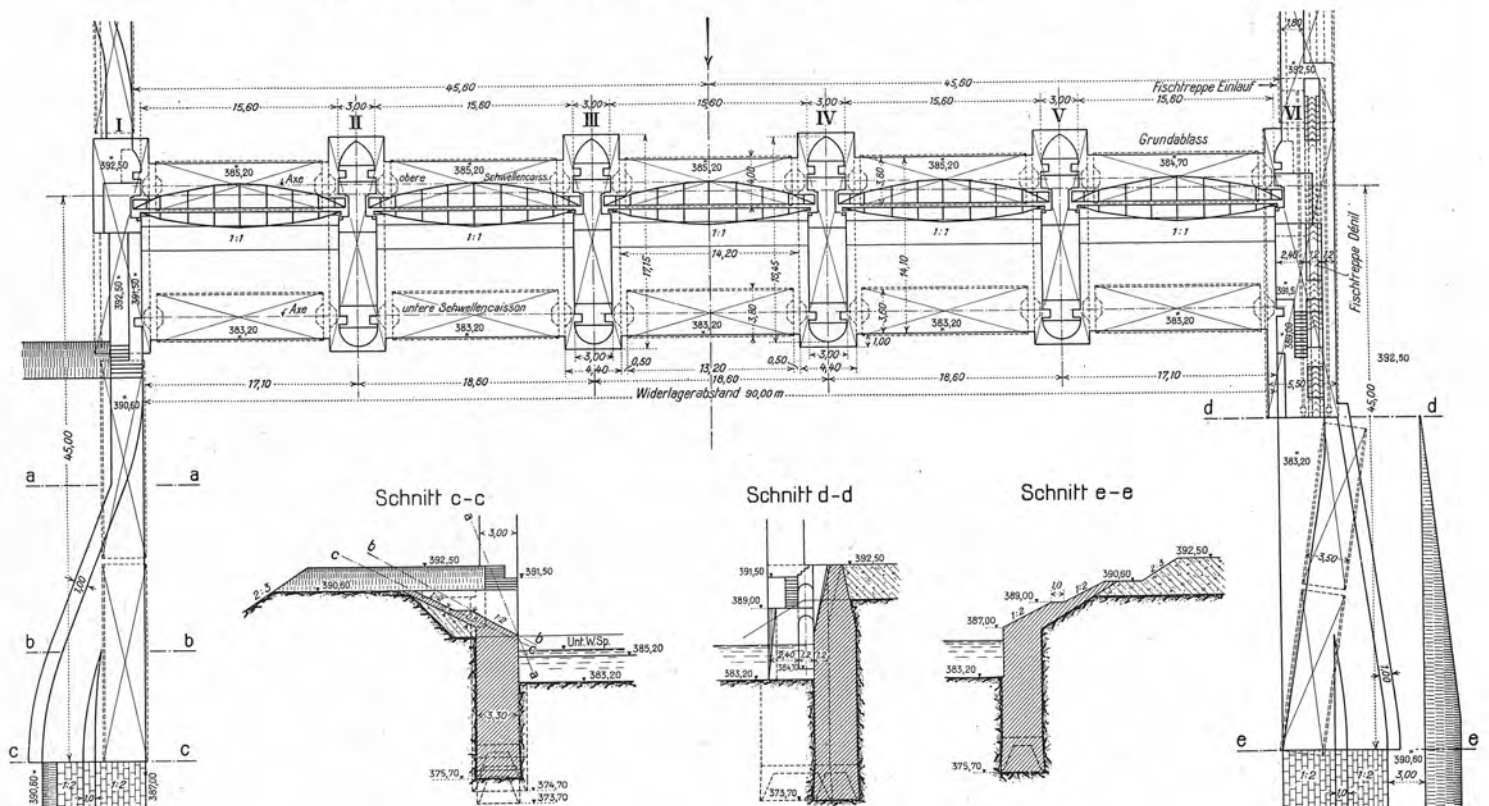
Grundriss des Stauwehres und Schnitte der Unterwasser-Flügelmauern. — Masstab 1:600.
